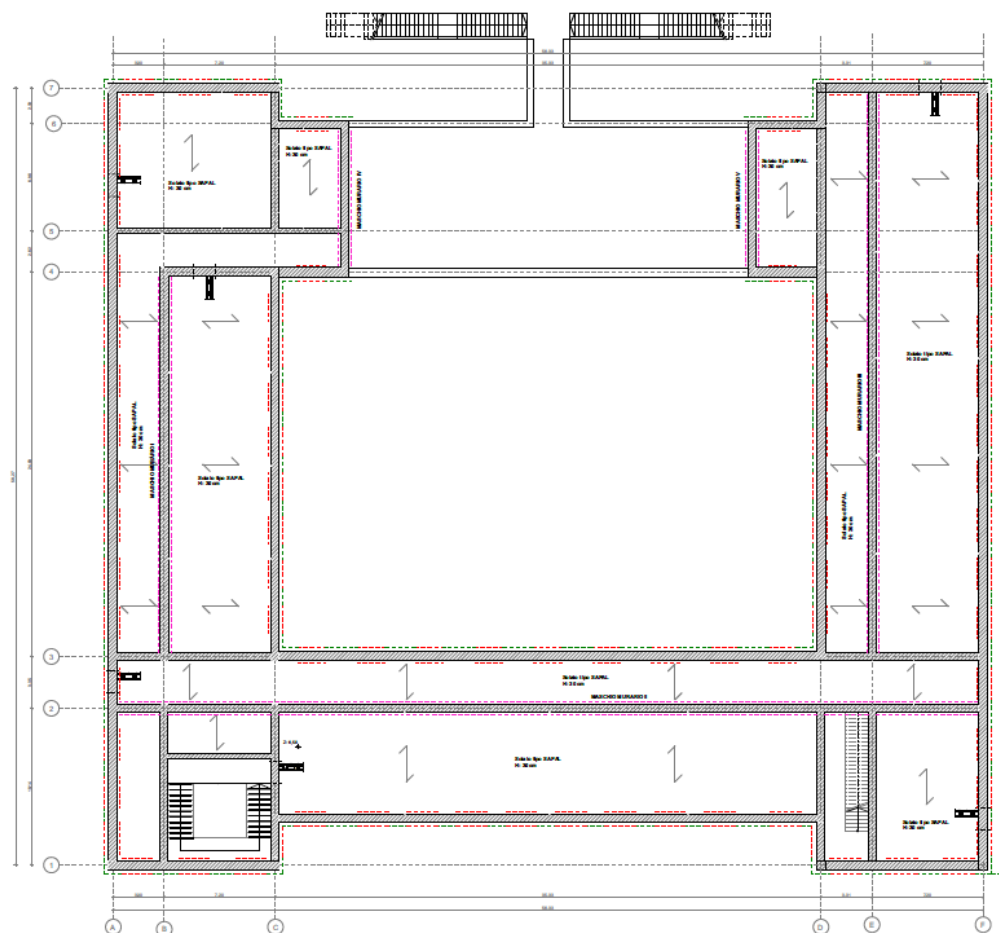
Pianta carpenteria stato di progetto – Piano terra
